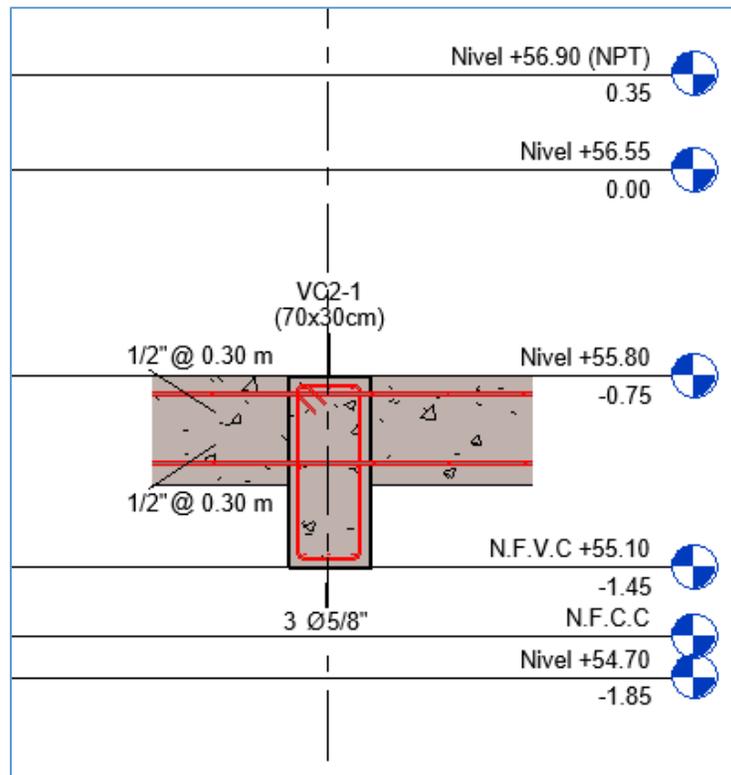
Detalle de Viga de Cimentación según Expediente Técnico.
